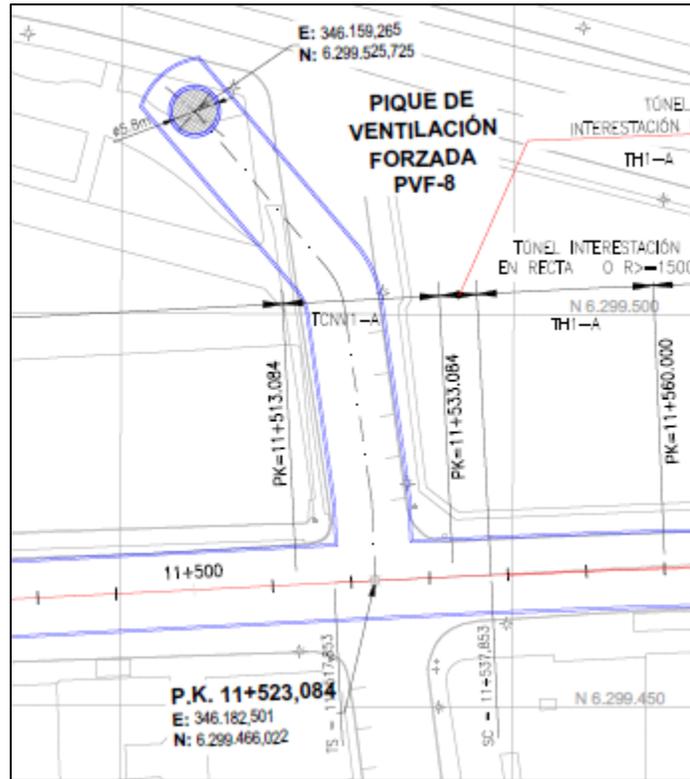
Planta Emplazamiento Pique Ventilación Forzada Morande
